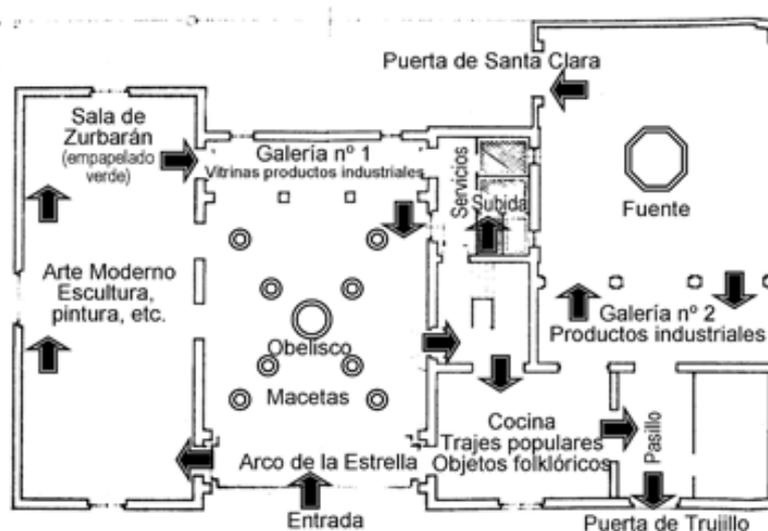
Pabellón de Extremadura. Plano de la planta baja con el recorrido propuesto
